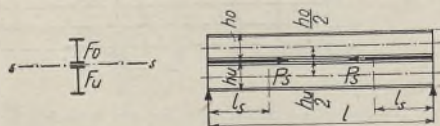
Ermittlung von Trägerdurchbiegung und Trägerbelastung.
